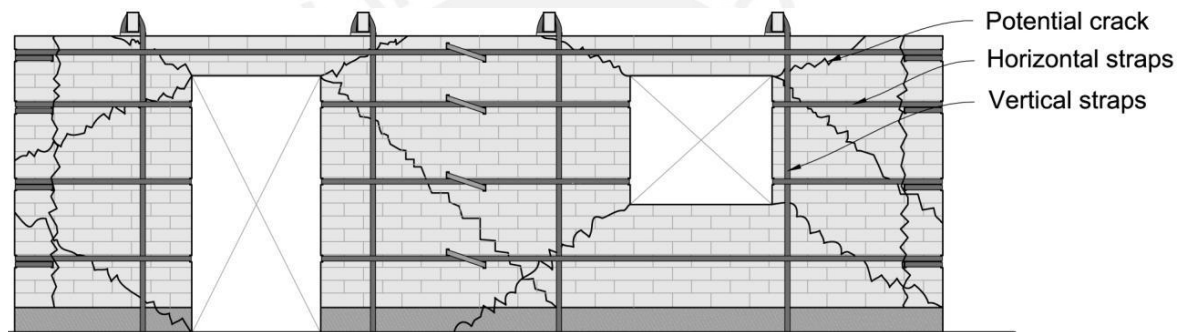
(Elevación) Modelo de falla de casa de adobe reforzado con tiras de llantas usadas (Charleson, 2011)
